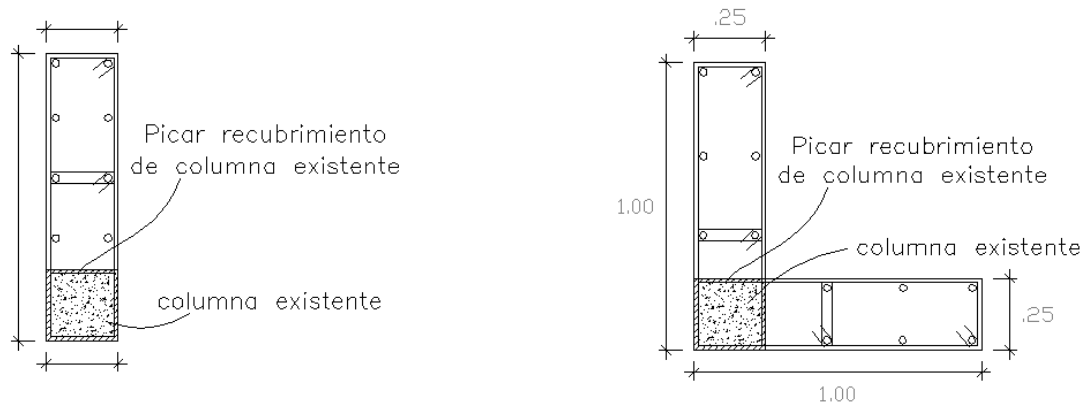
Detalle de reforzamiento para columna existente y esquinera
